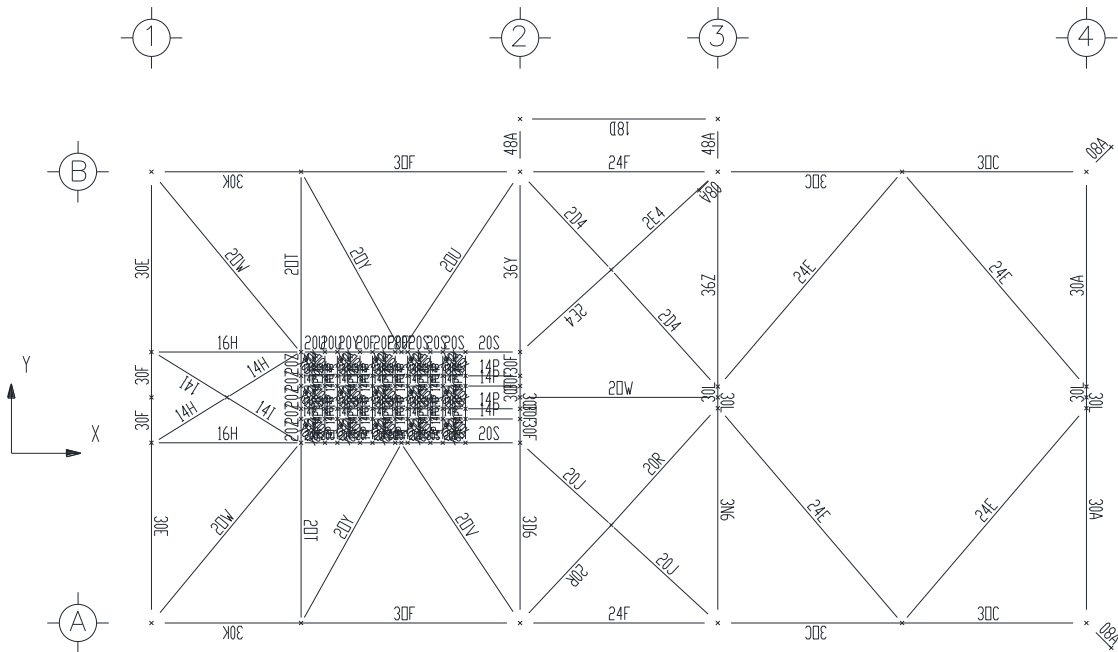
Grupos en Elev. (-) 63.093 m, subestructura
